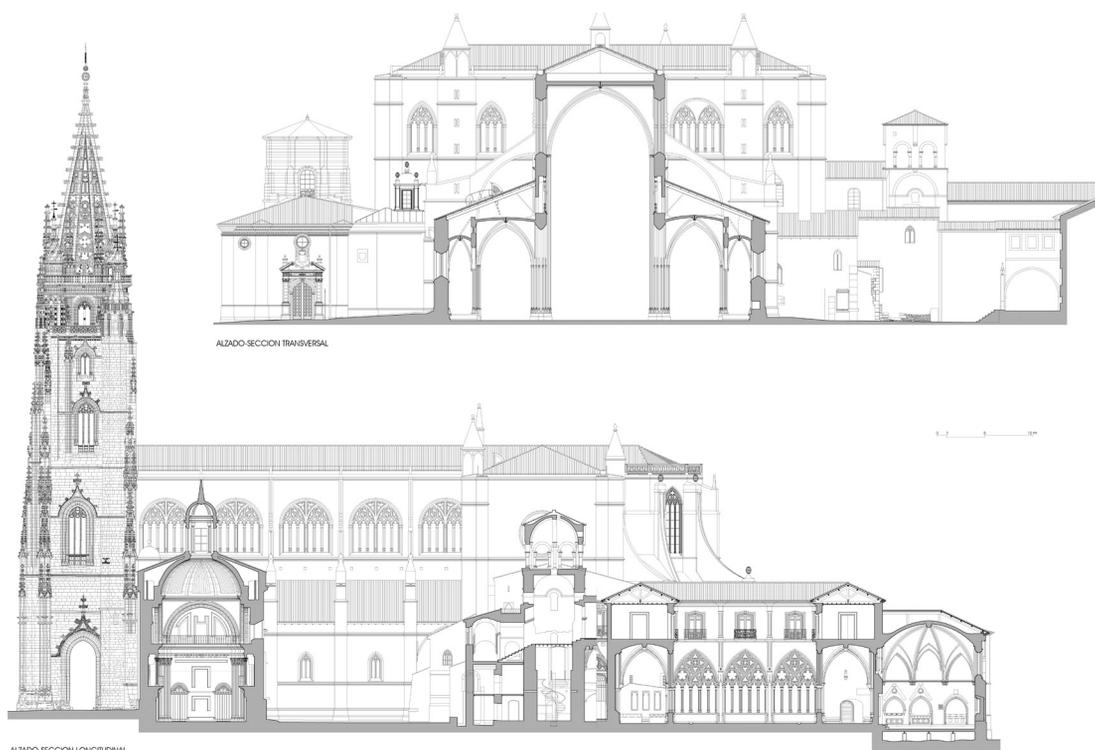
Alzado-sección general: transversal y longitudinal. Cuenca y Hevia.
